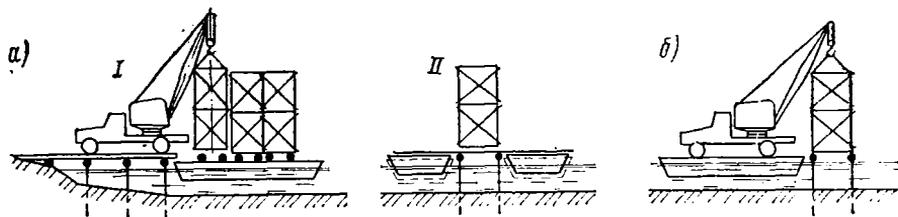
Схема монтажа деревянных опор из пространственных блоков:
